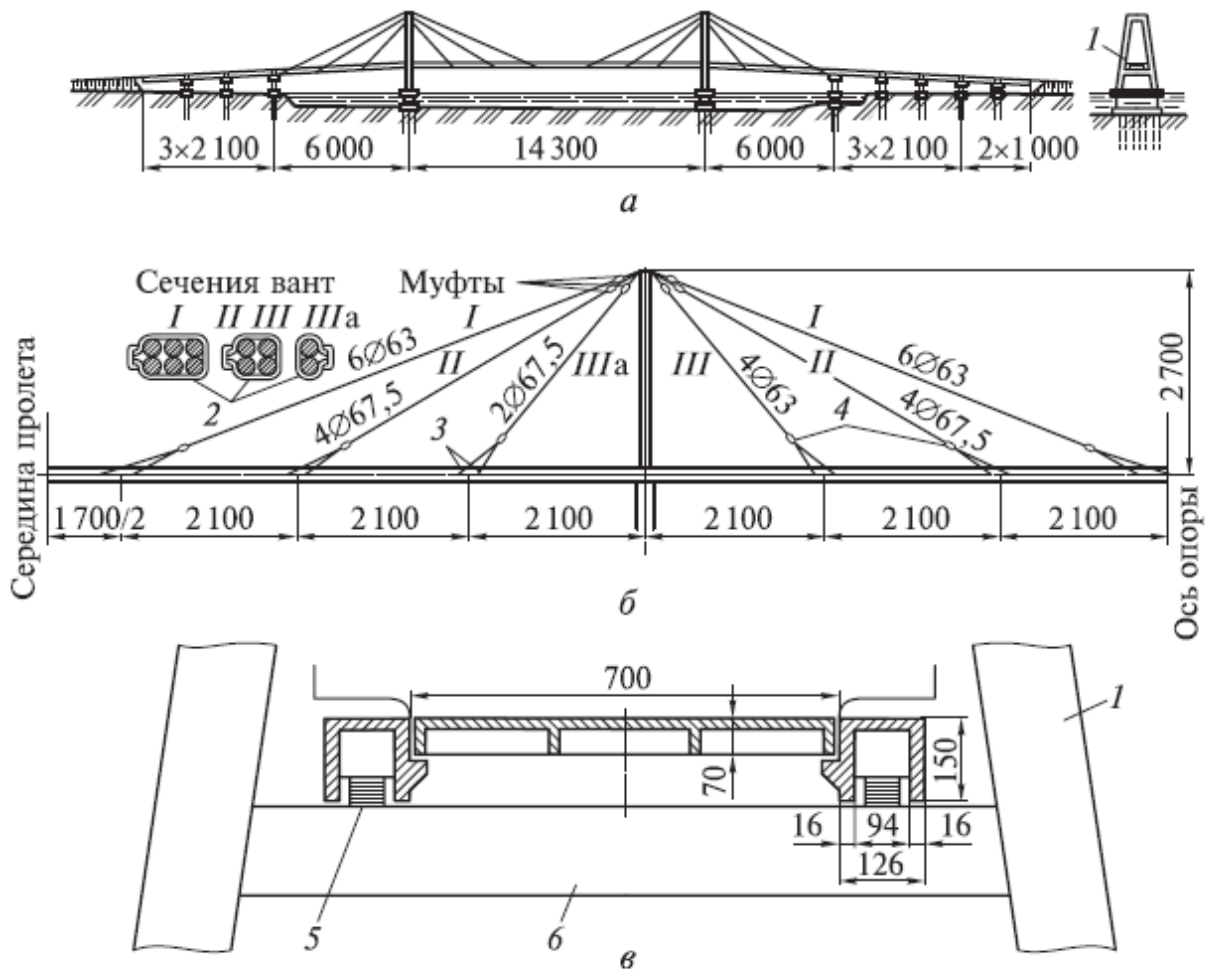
Фасад (а), схема вант (б) и поперечное сечение балки жесткости (в) вантового моста в г. Киеве:
